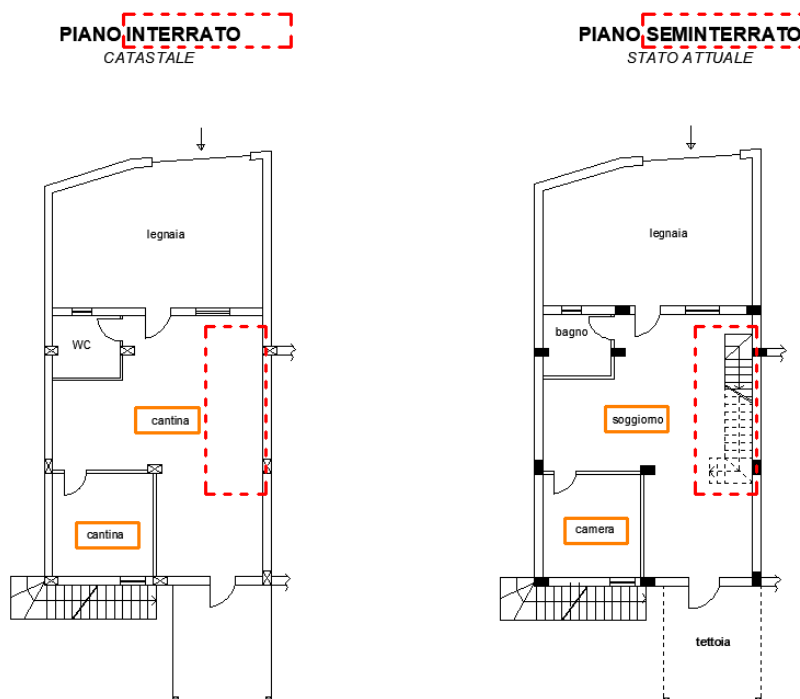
Confronto tra planimetria catastale e planimetria stato attuale
